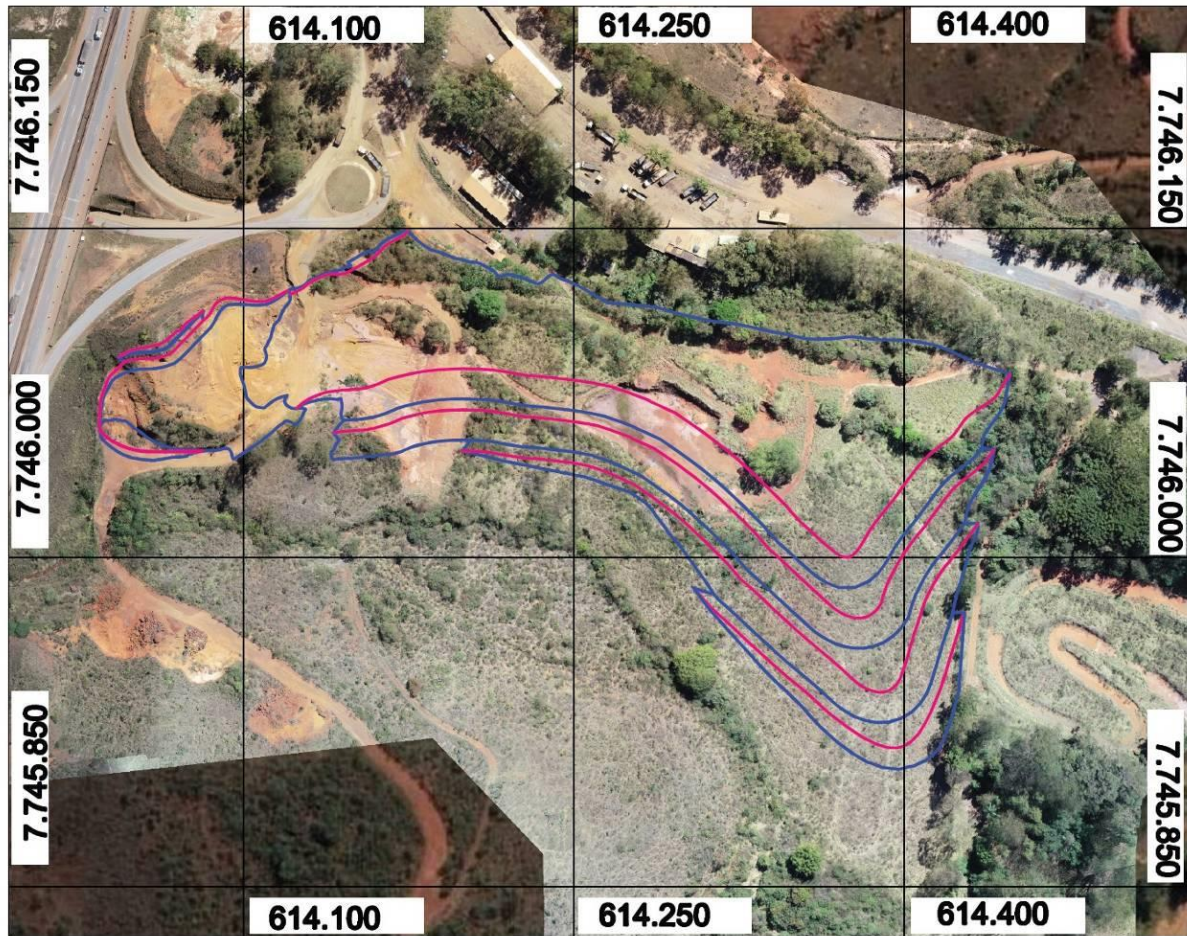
Planta da configuração final da Pilha Trevo, sobre imagem de satélite.
